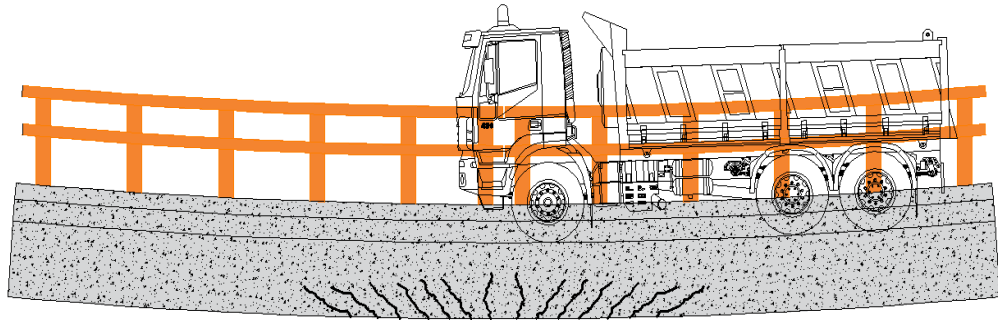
8: Fisuras por inestabilidad elástica (Fuente: Elaboración propia).
